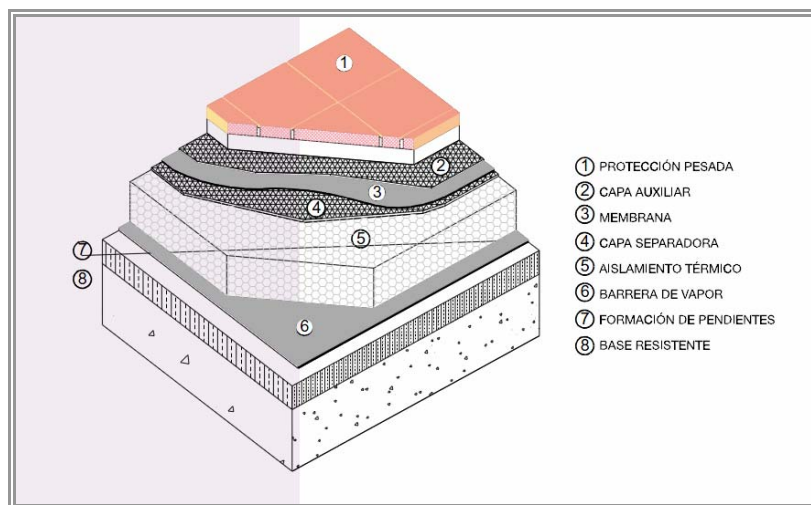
Esquema de la solución tipo de cubierta plana tradicional. (ANAPE)
